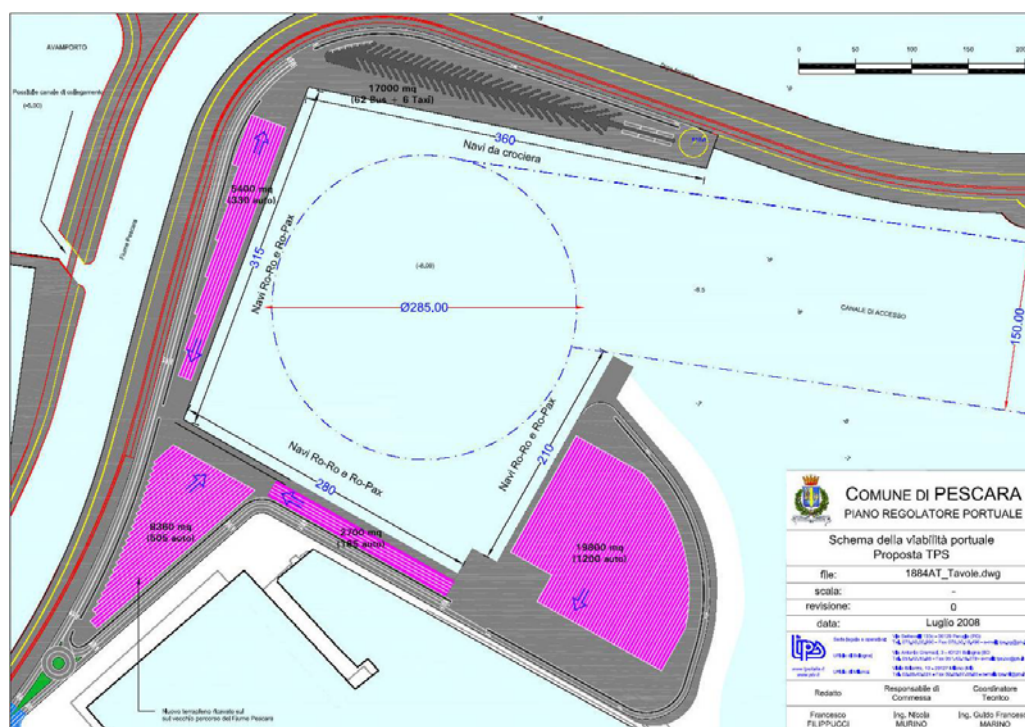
Planimetria del progetto TPS sulla viabilità interna al nuovo porto
